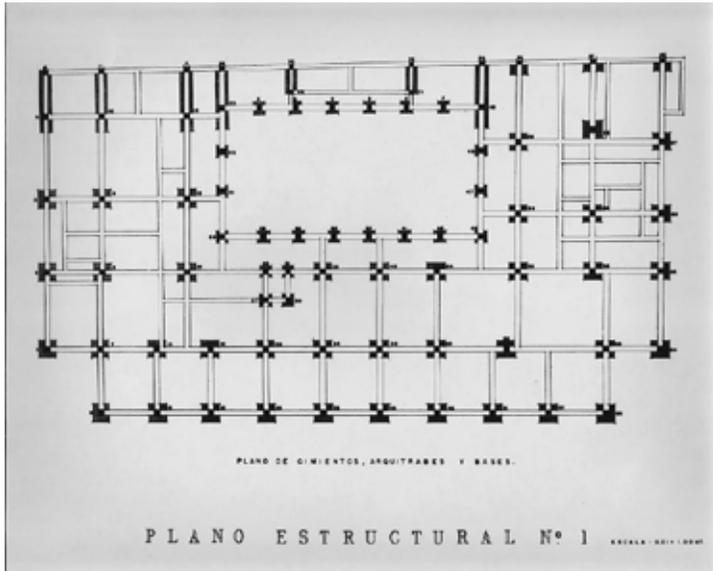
Ayuntamiento planta estructural nº 1. Documentos del Dr. Prat. OCC.
